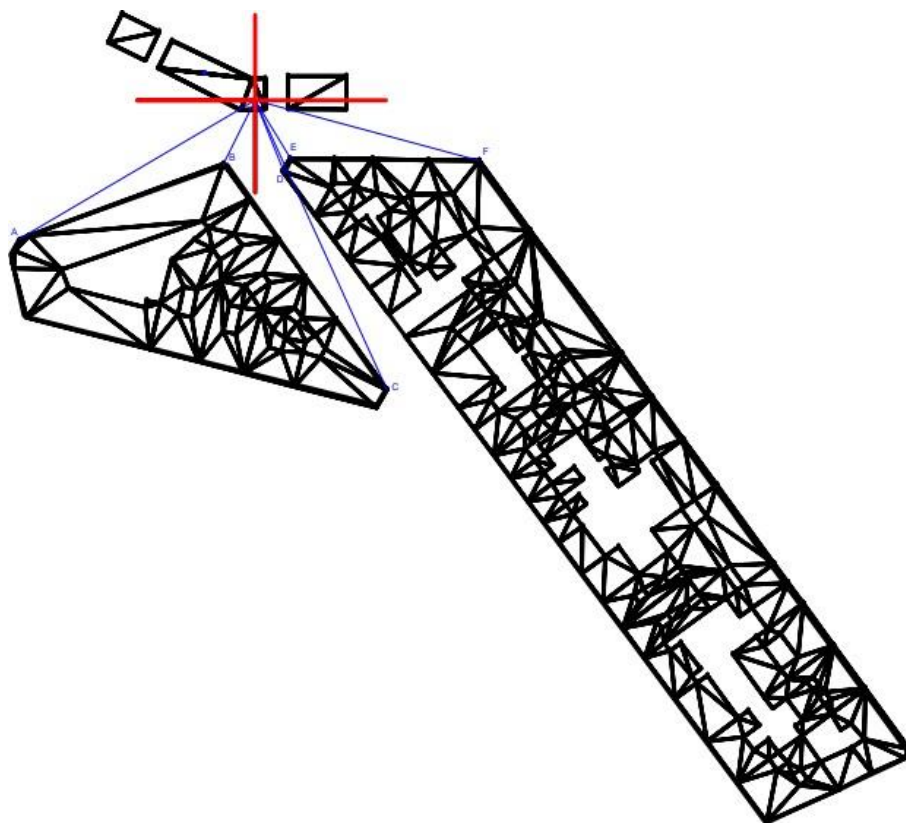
Plano exportado de Google Earth a Autocad para el cálculo de los ángulos de inclinación y elevación reales
